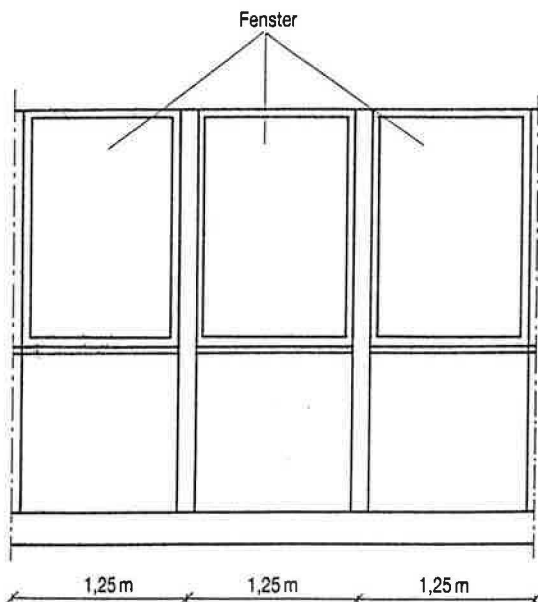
Fassadenausschnitt für einen Büroraum (3-Raster) in konventioneller Bauweise.
